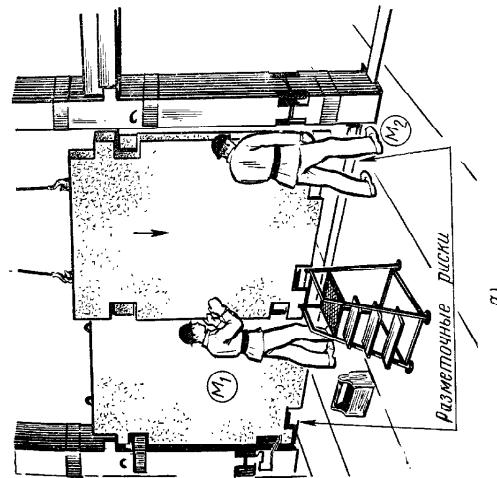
Монтаж стен жесткости в каркасных зданиях:
